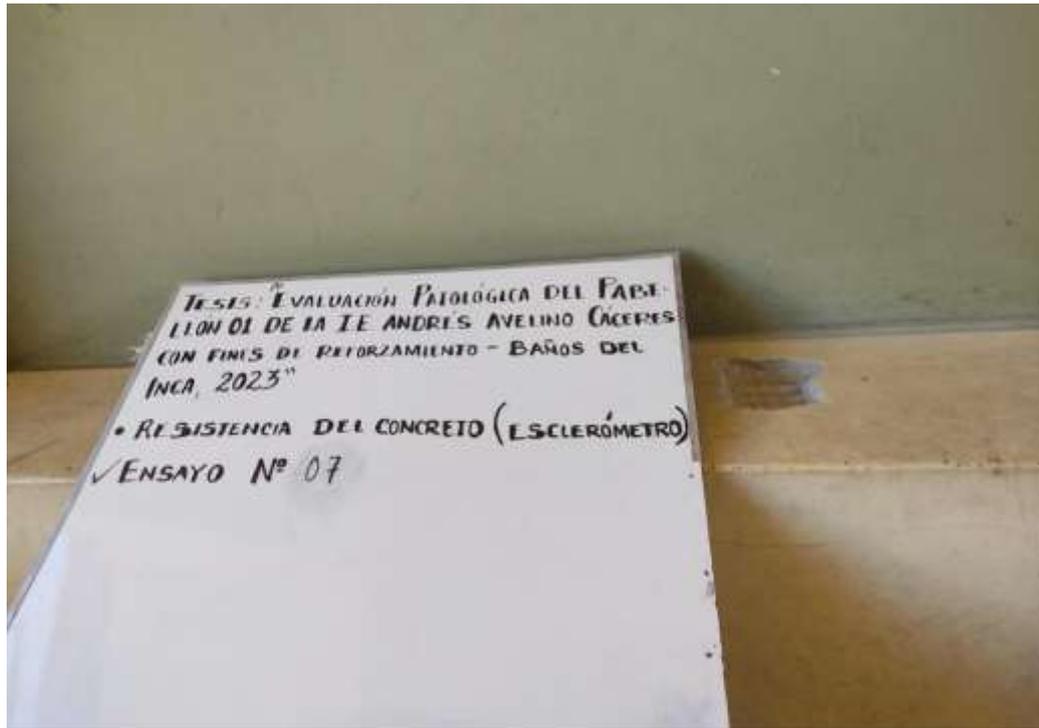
Ensayo de esclerometría en una de las vigas del primer piso.
